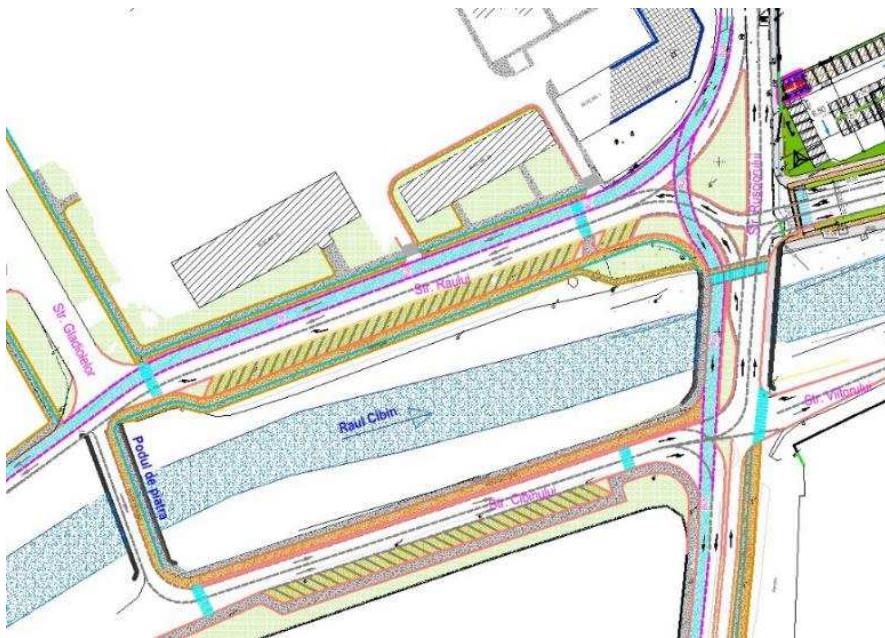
Propunere reconfigurare zona dintre Podul de Piatră și str. Rusciorului, (Sursa: prelucrare proiectant)
